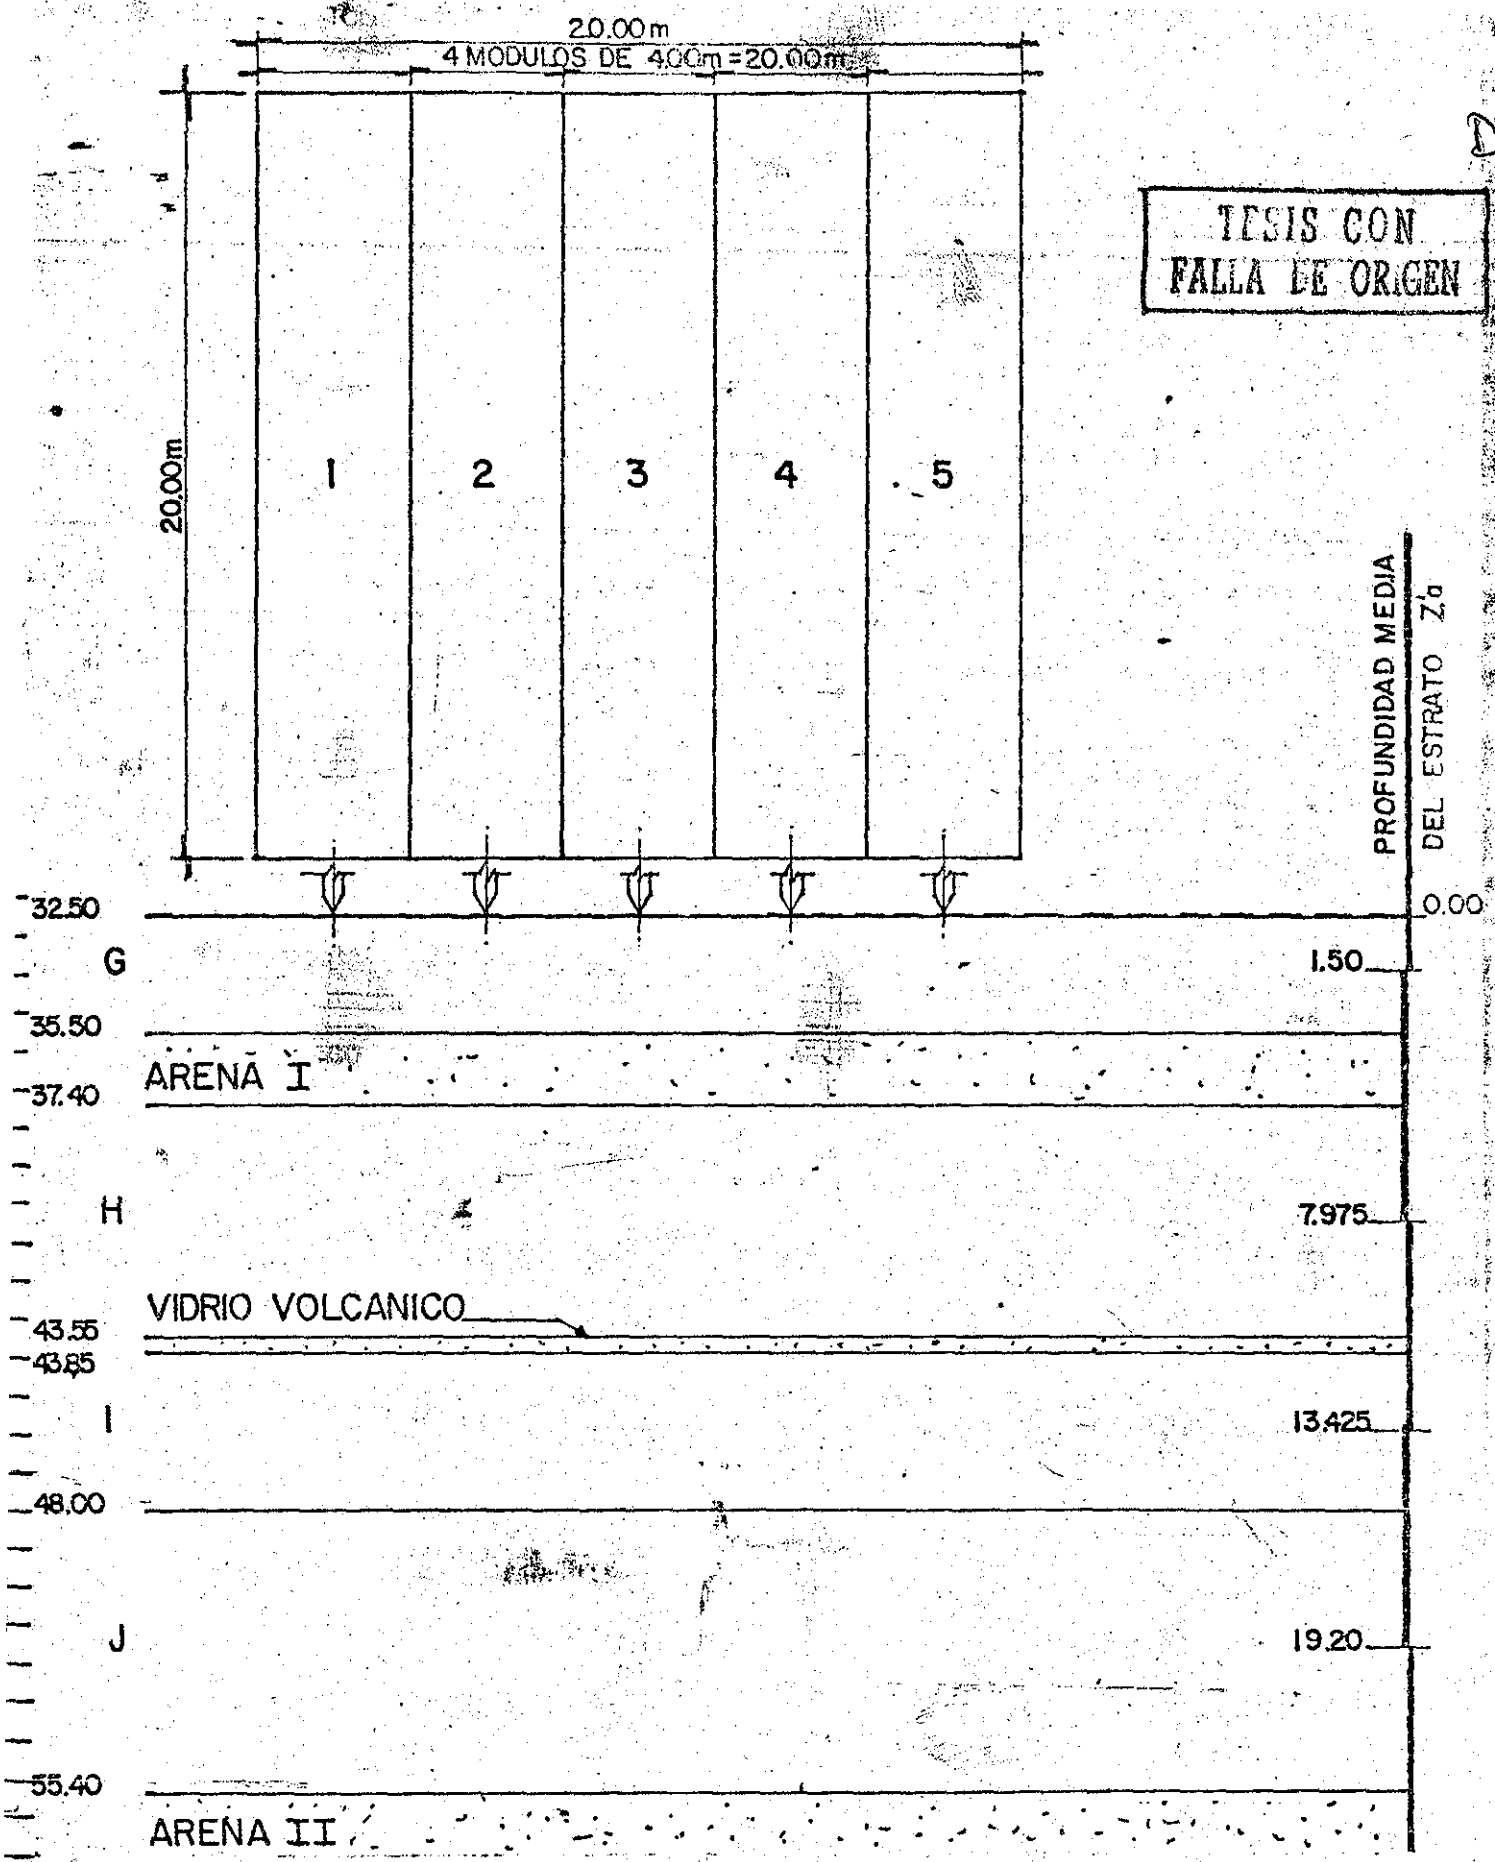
CROQUIS DE LA PLANTA A 32.5m, DIVISION DE FAJAS Y ESTRATIGRAFIA BAJO ESE NIVEL
